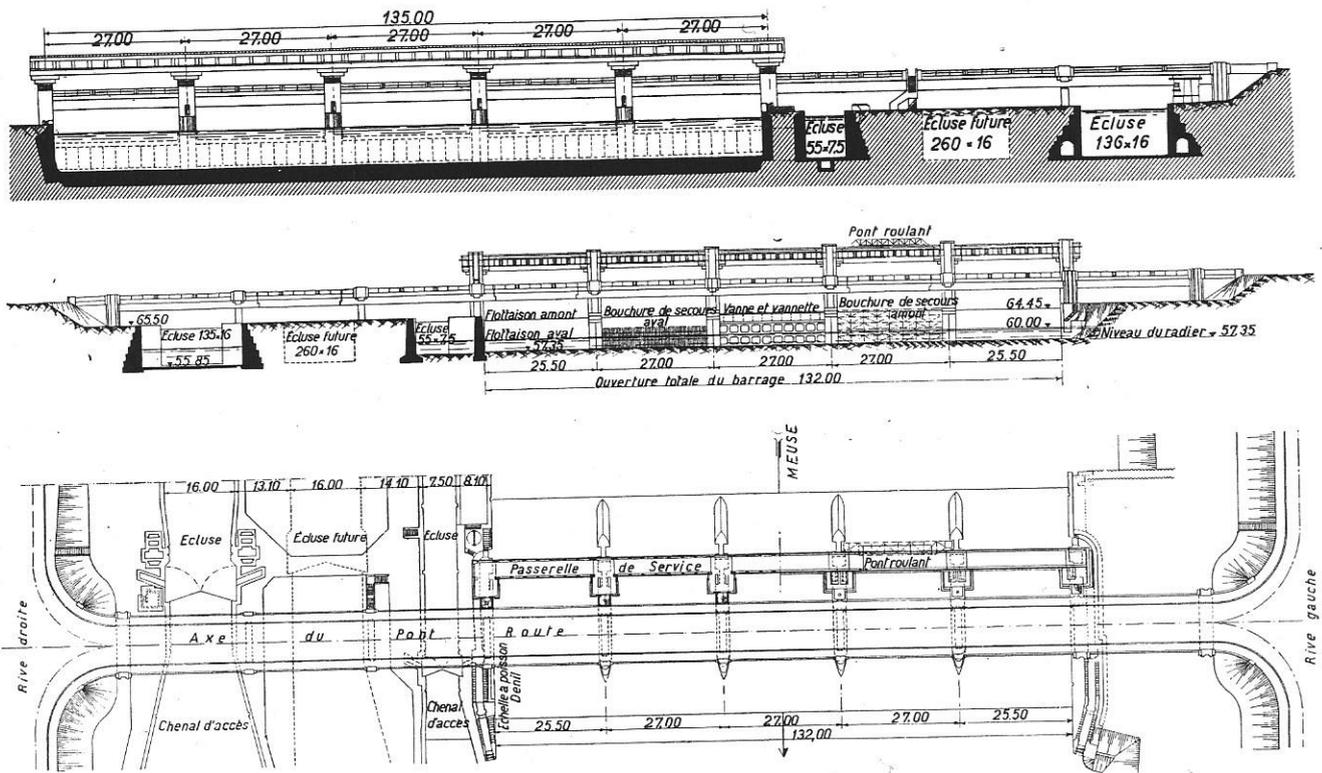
, 8 et 9. — Elévation amont, élévation aval et plan du barrage.
